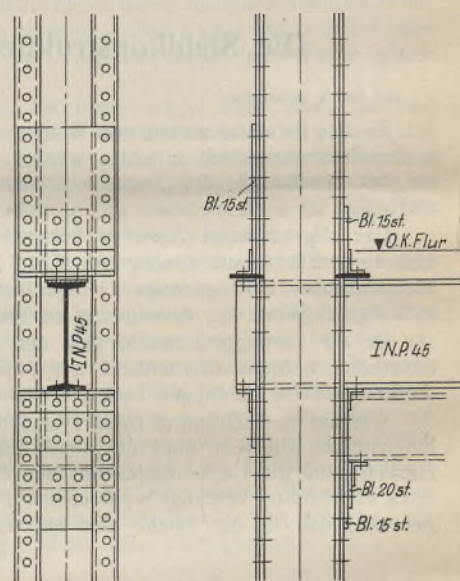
Außenstütze mit Deckenträgeranschluß.
